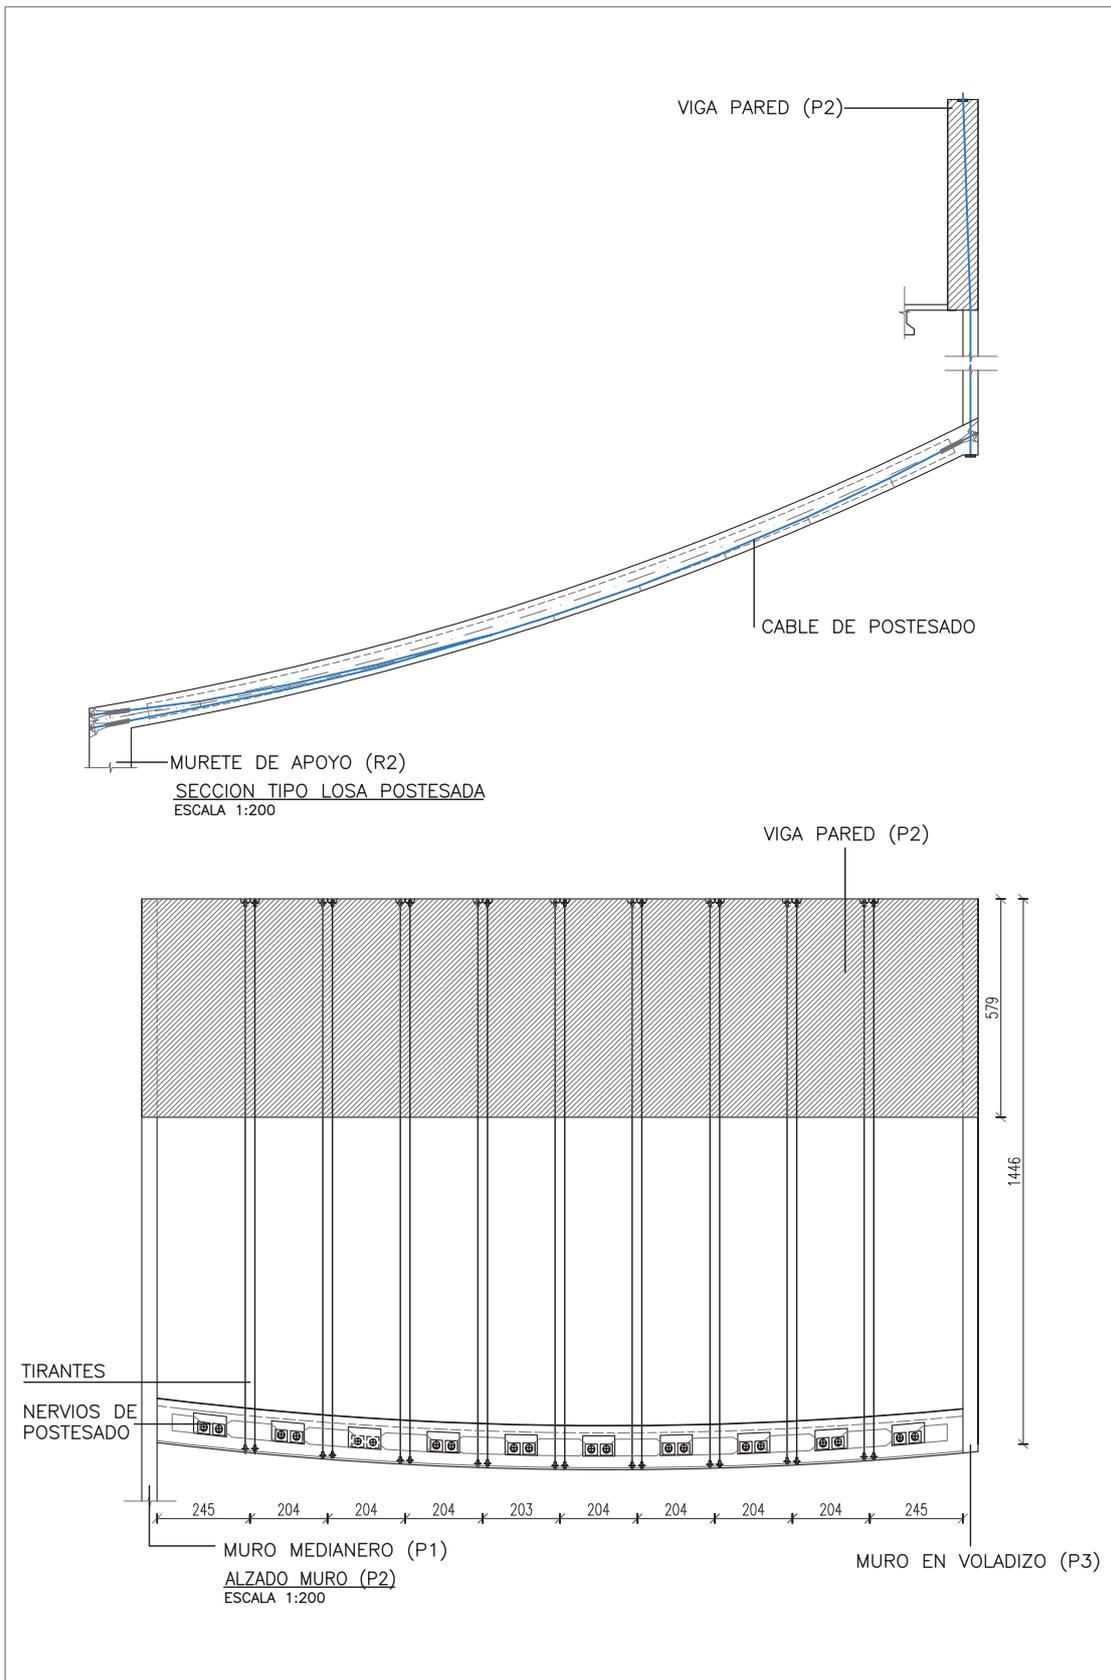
Alzado y sección tanto de la viga pared como de la losa de la platea. Nervios y cable de postesado. Escala 1:200 [27]
